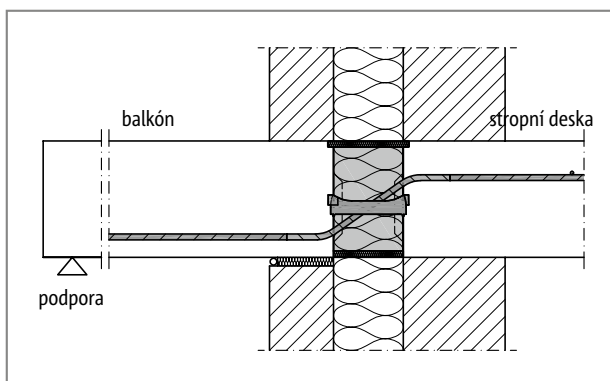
Schöck Isokorb® XT typ QL: Balkón se sloupovými podporami
